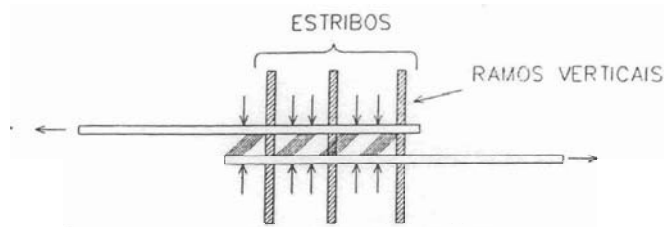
Detalhe dos ramos verticais dos estribos na região de emenda [FUSCO, 1994]
